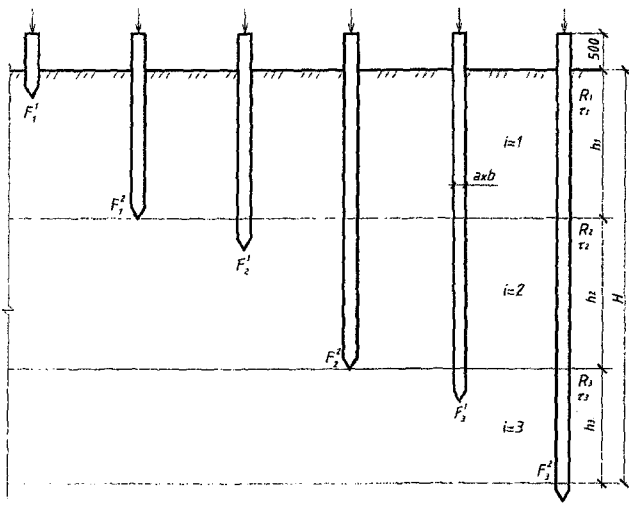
Схема к определению несущей способности сваи F_i в пределах i -го слоя грунта на примере трехслойного основания
